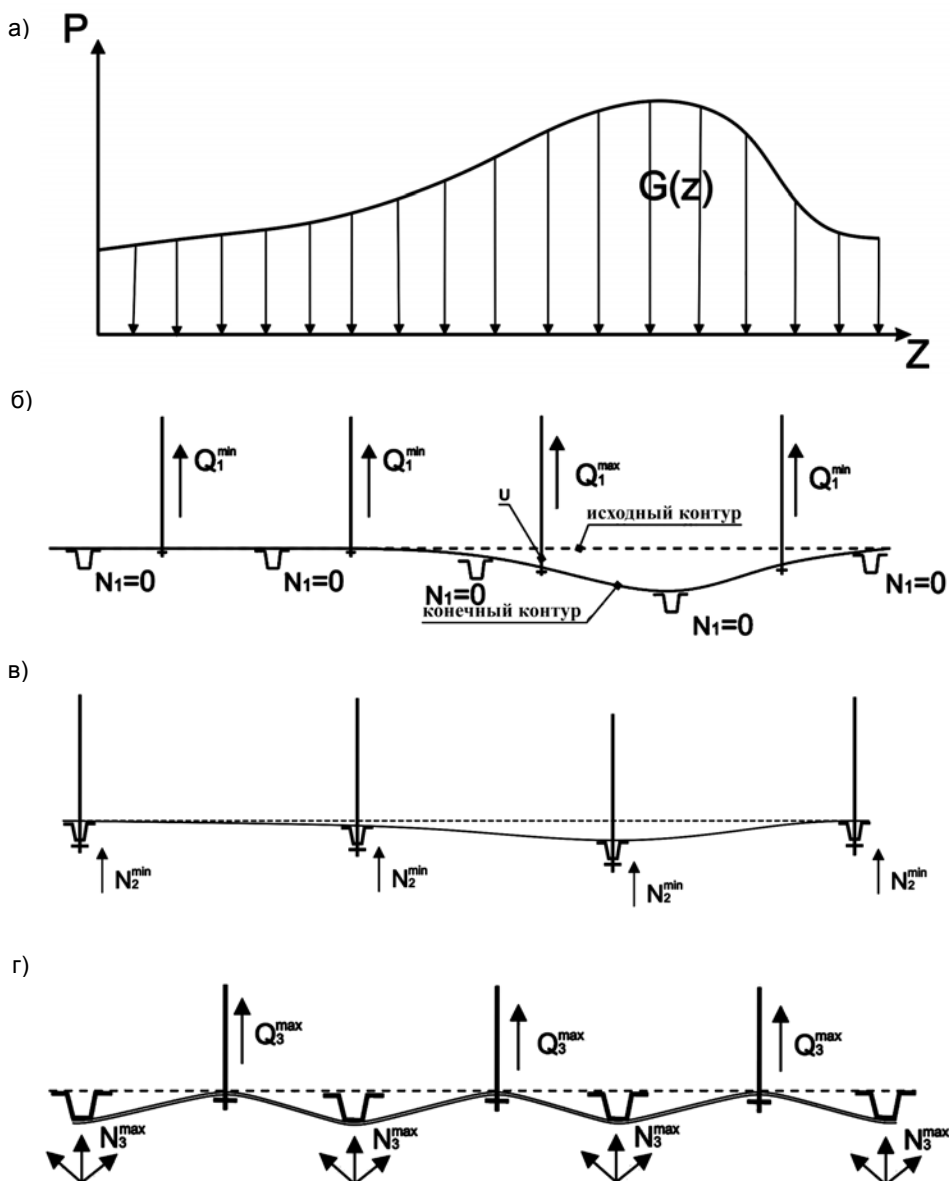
Эпюры $G(z)$ нагрузки (а) вдоль выработки и схемы деформирования крепежных конструкций по группам вариантов связей рам и анкеров: б) без связи; в) жесткая связь; г) податливая связь
